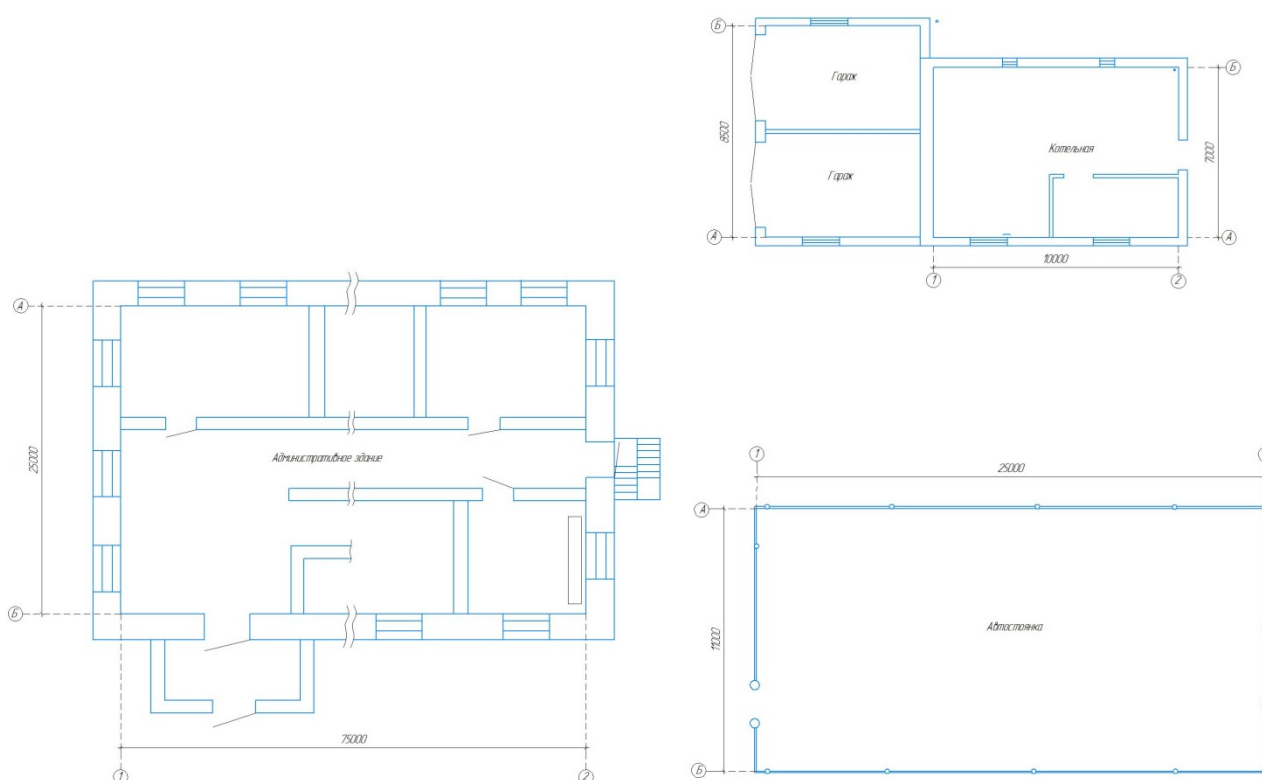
Генеральный план размещения зданий ООО "МДМ"
